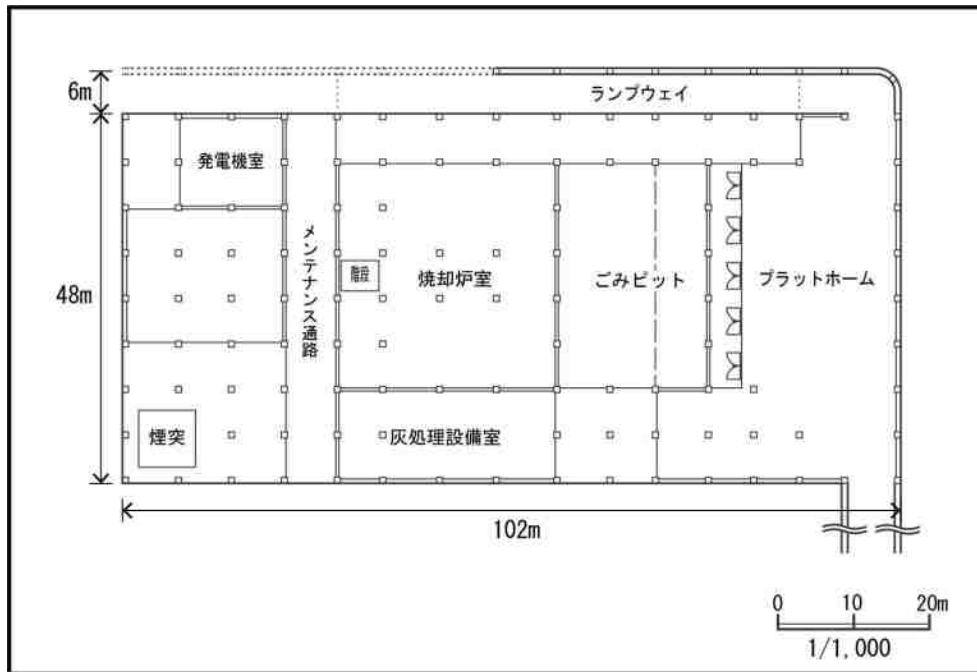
(3) 新施設の平面図（新焼却処理施設 2 階）
